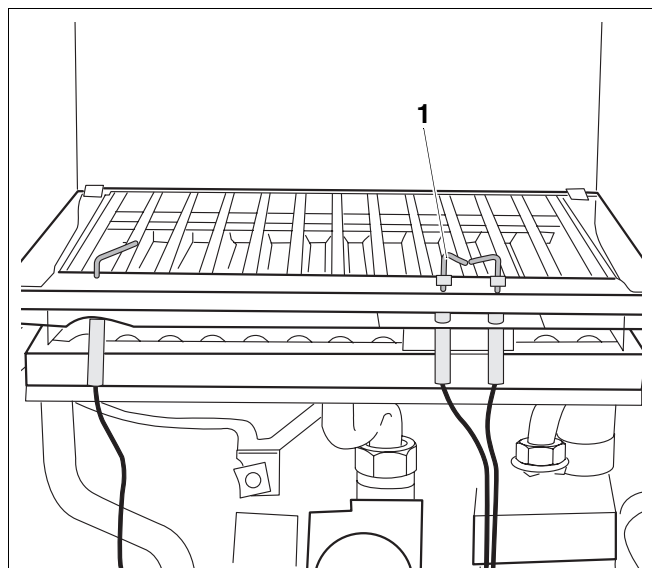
Înlocuirea electrodului de aprindere U002/U004
